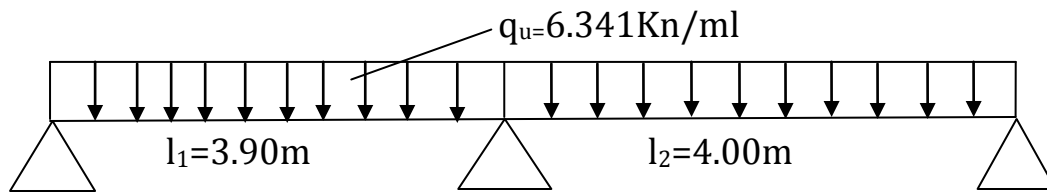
Schéma statique de la poutre continue reposant sur trois appuis
